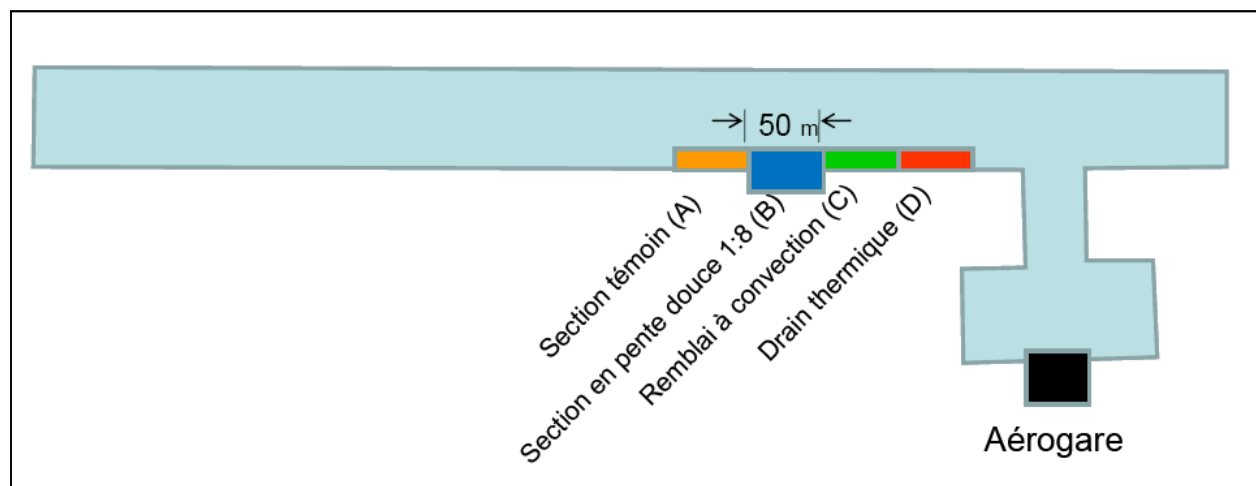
Plan de la zone des sections (Lemelin et coll., 2008)
